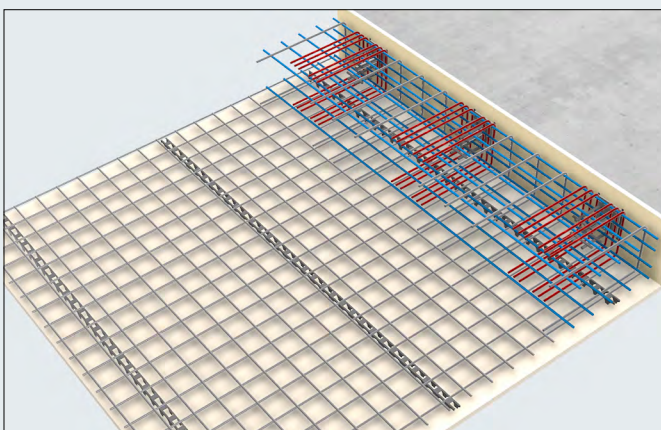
Restliche Zulagebewehrung je Dorn verlegen (Abstände beachten).
